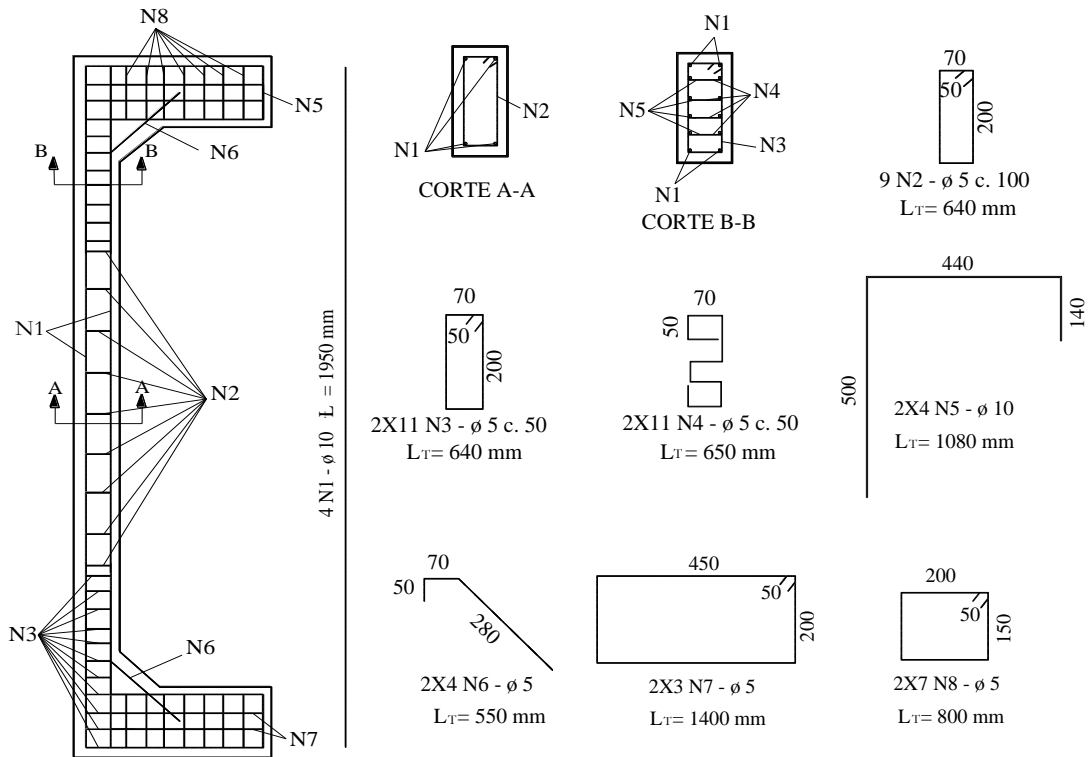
Detalhamento das armaduras da Série PCA4 (ADORNO, 2004)
